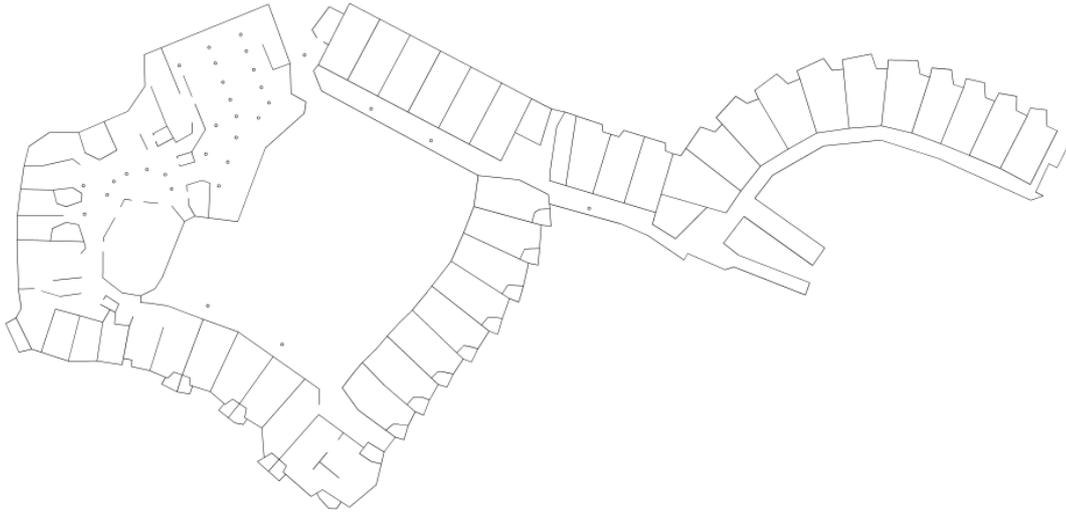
Planta del proyecto Pelgromhof; Fuente: elaboración propia
